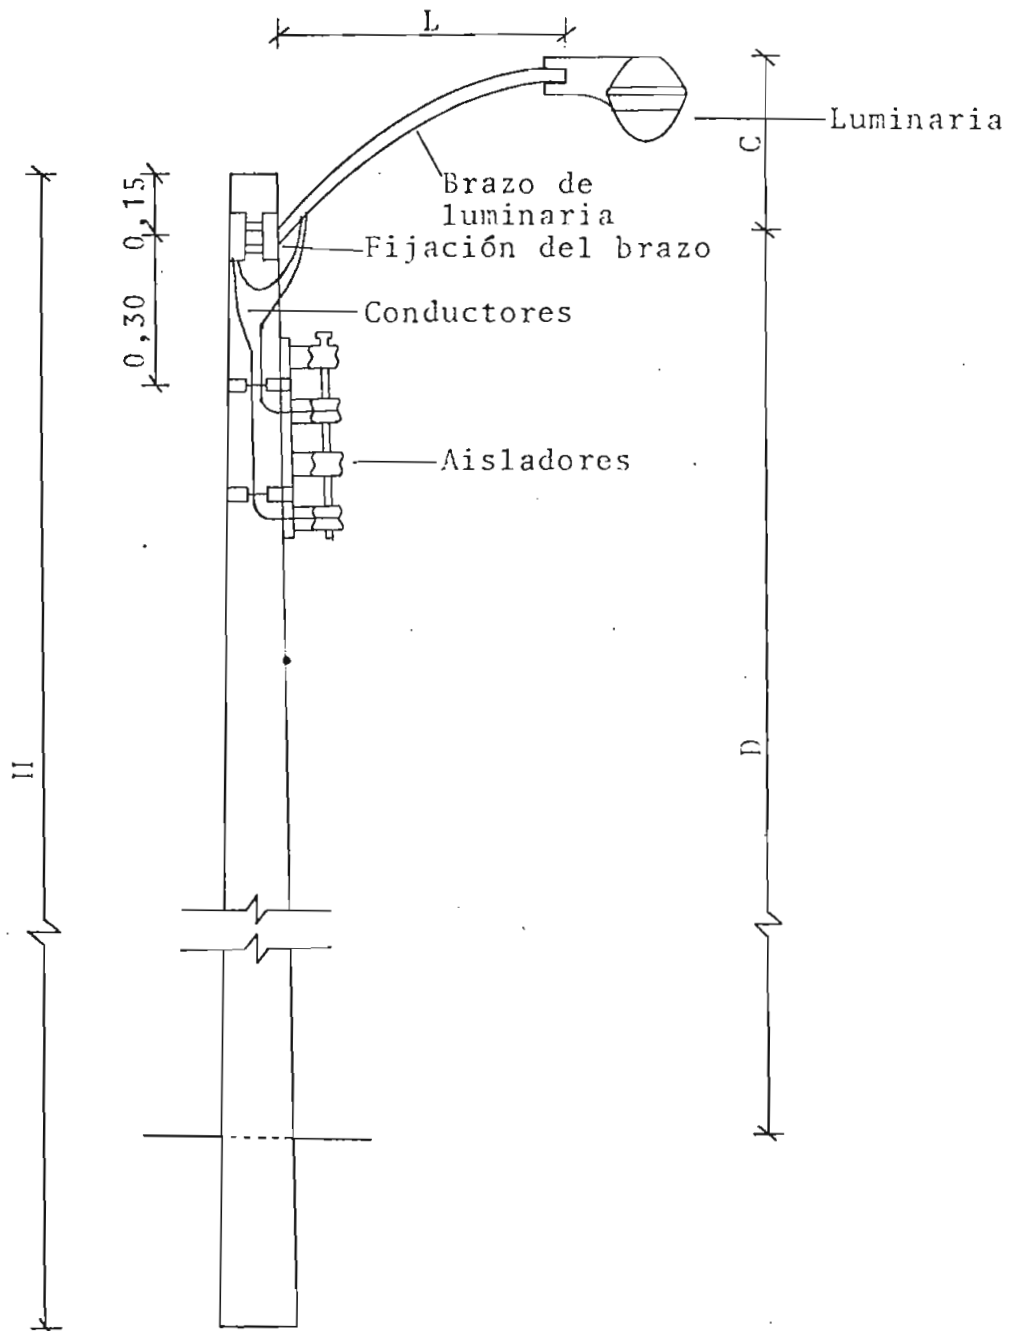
ESQUEMA DE APOYO PARA LUMINARIA Y RED DE BAJA TENSION
